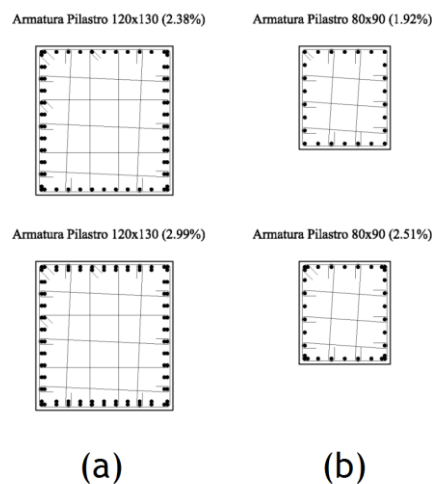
Sezioni dei pilastri; a) senza dispositivi; b) con dispositivi
